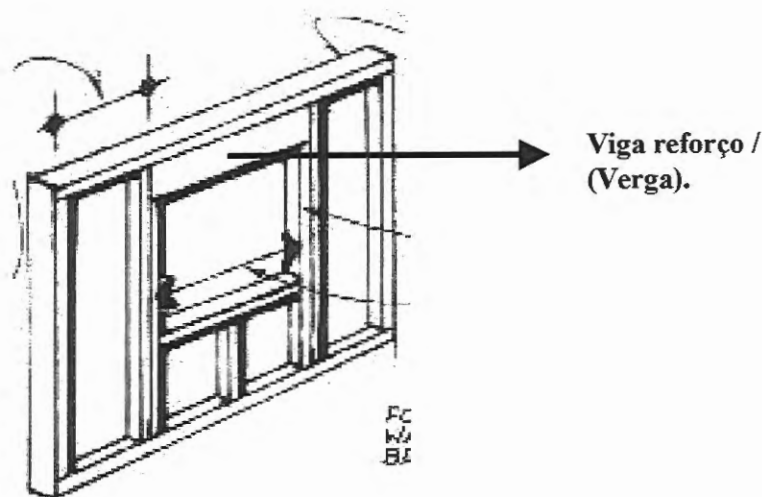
Painel estrutural com abertura, reforçado por uma viga (verga).
